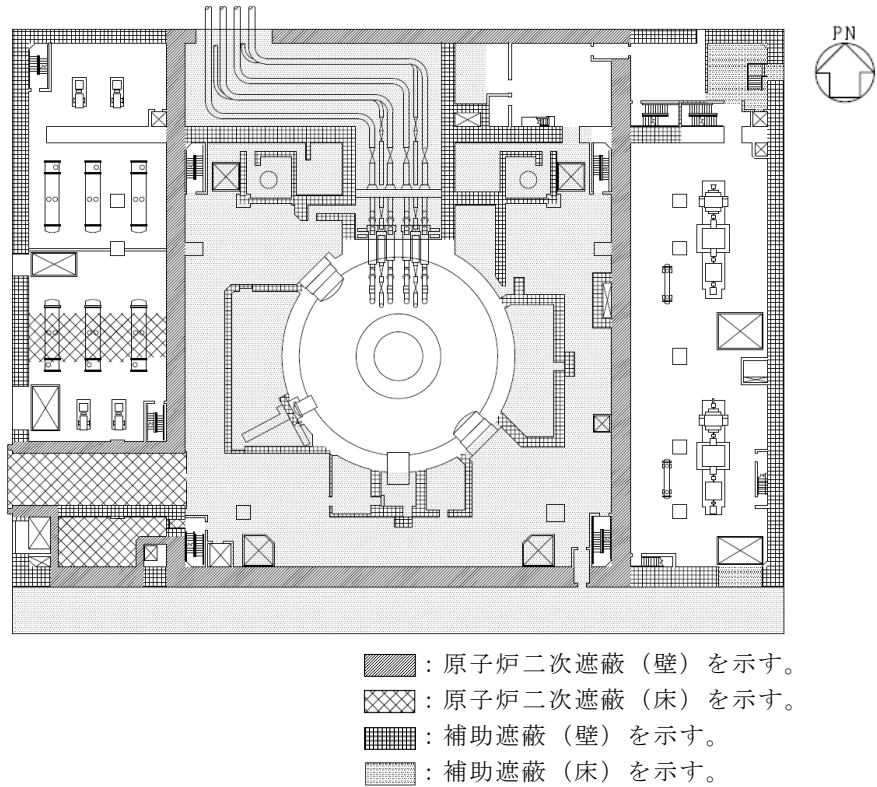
(4) 原子炉二次遮蔽及び補助遮蔽（原子炉建物）の範囲の平面図
